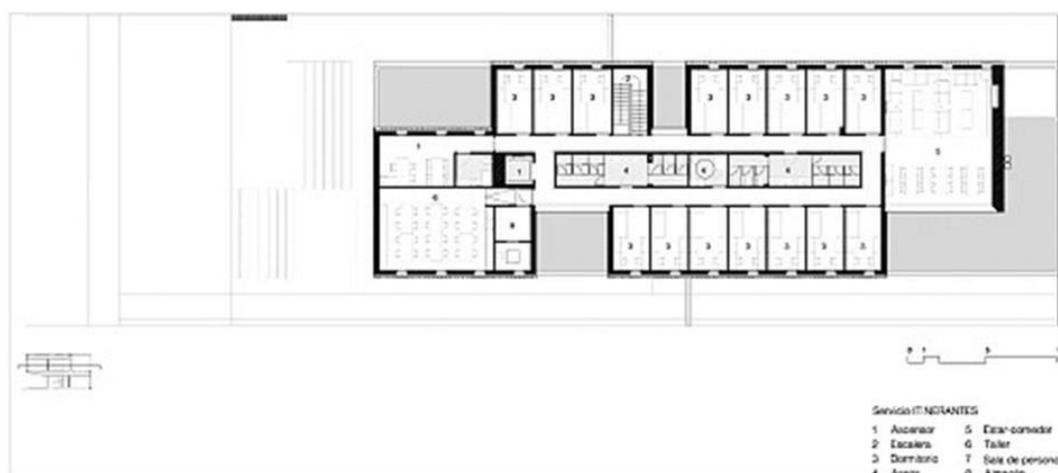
Planta primeiro pavimento do projeto Shelter Home
